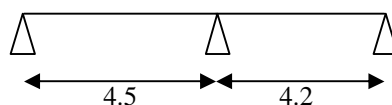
Schéma du 3<sup>eme</sup> type de poutrelle
